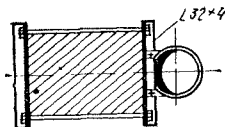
Кронштейны для крепления на железобетонных и кирпичных колоннах вертикальных воздуховодов круглого сечения диаметром до 595 и выше 595 мм
